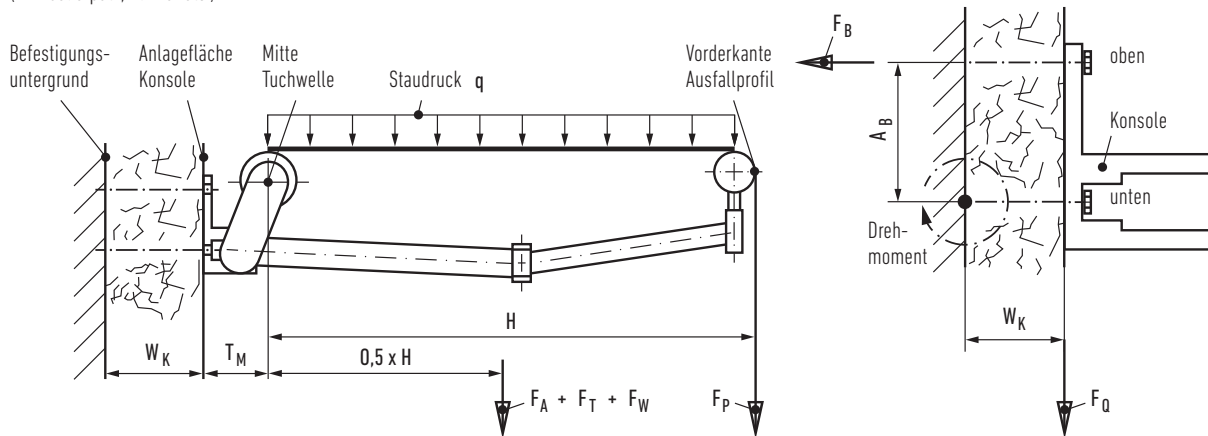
Markisenbefestigung auf nicht druckfestem Befestigungsuntergrund
